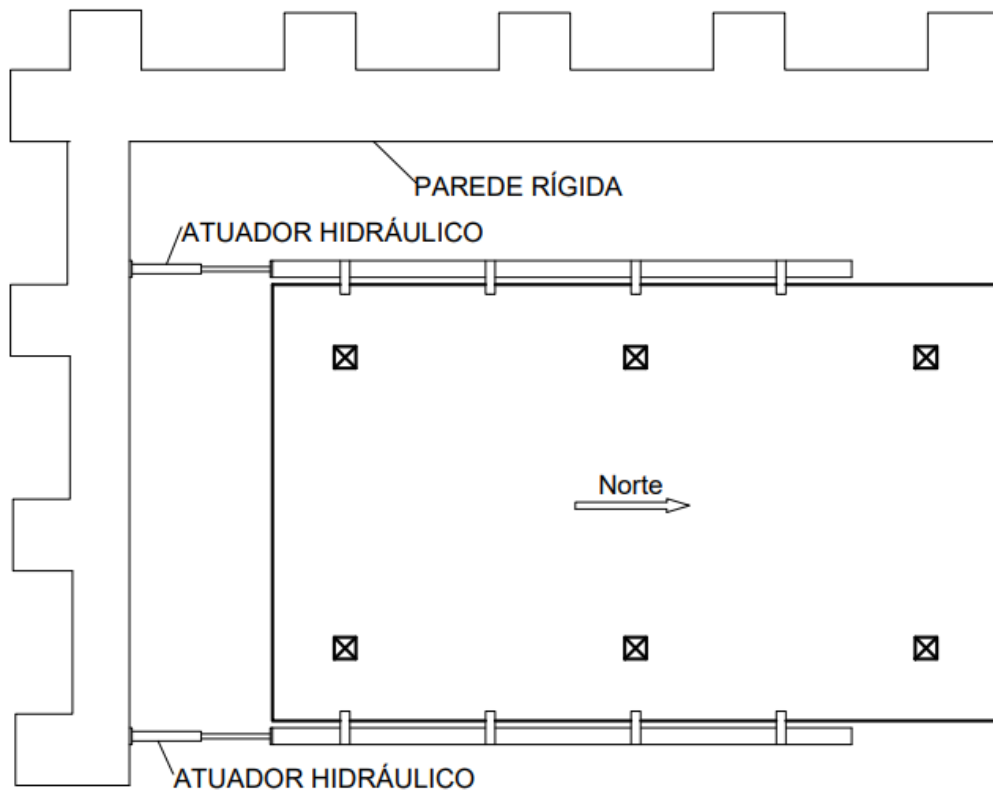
Vista em planta do sistema de ensaio. Adaptado de Fick (2008).
